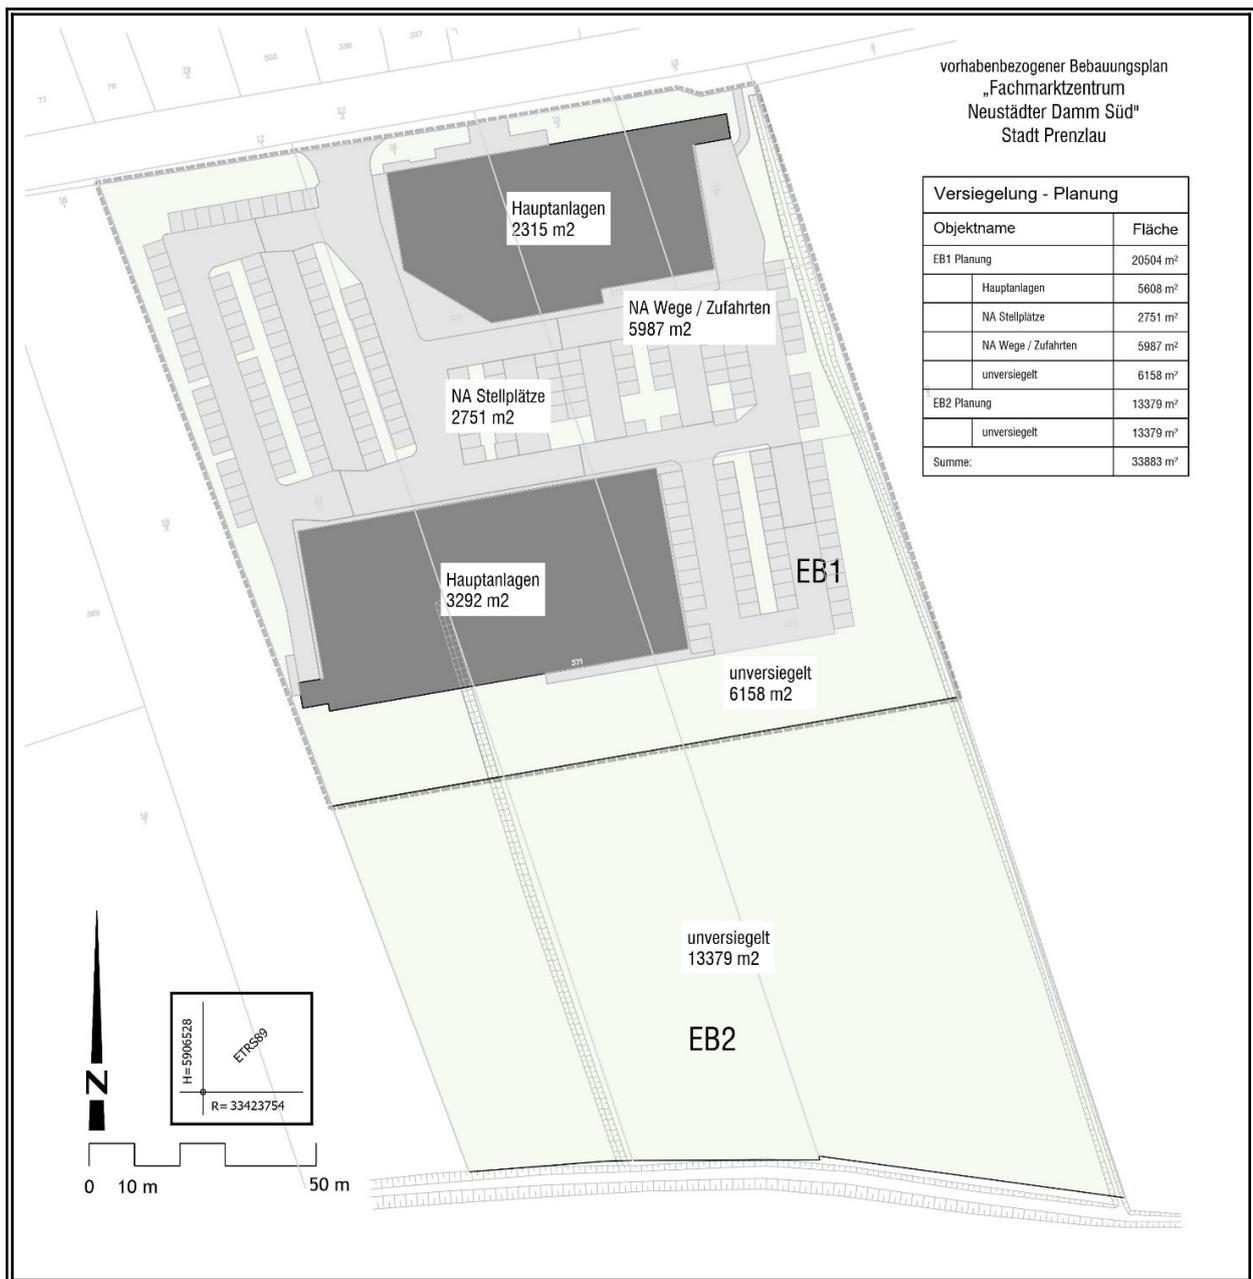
Lageplan Versiegelung (Planung gem. vorhabenbezogenen B-Plan)
